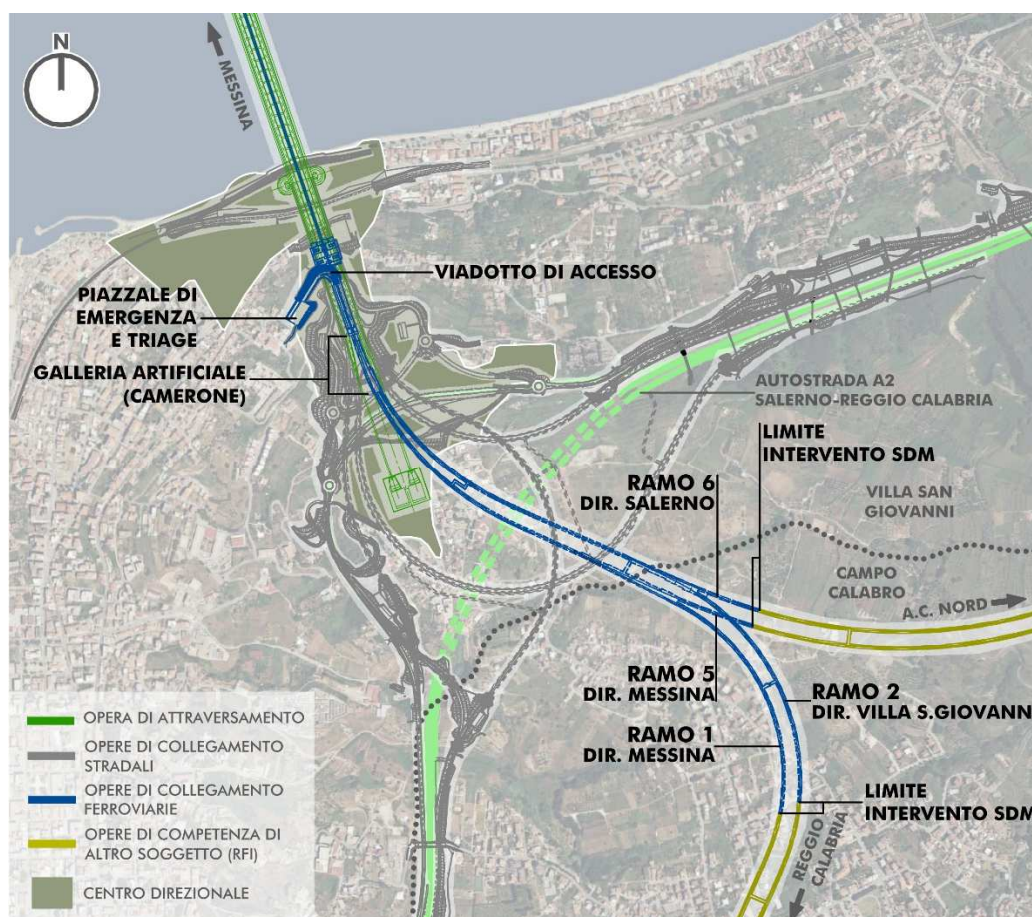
Stralcio planimetrico con indicazione dei rami costituenti i collegamenti ferroviari di progetto sul versante Calabria
